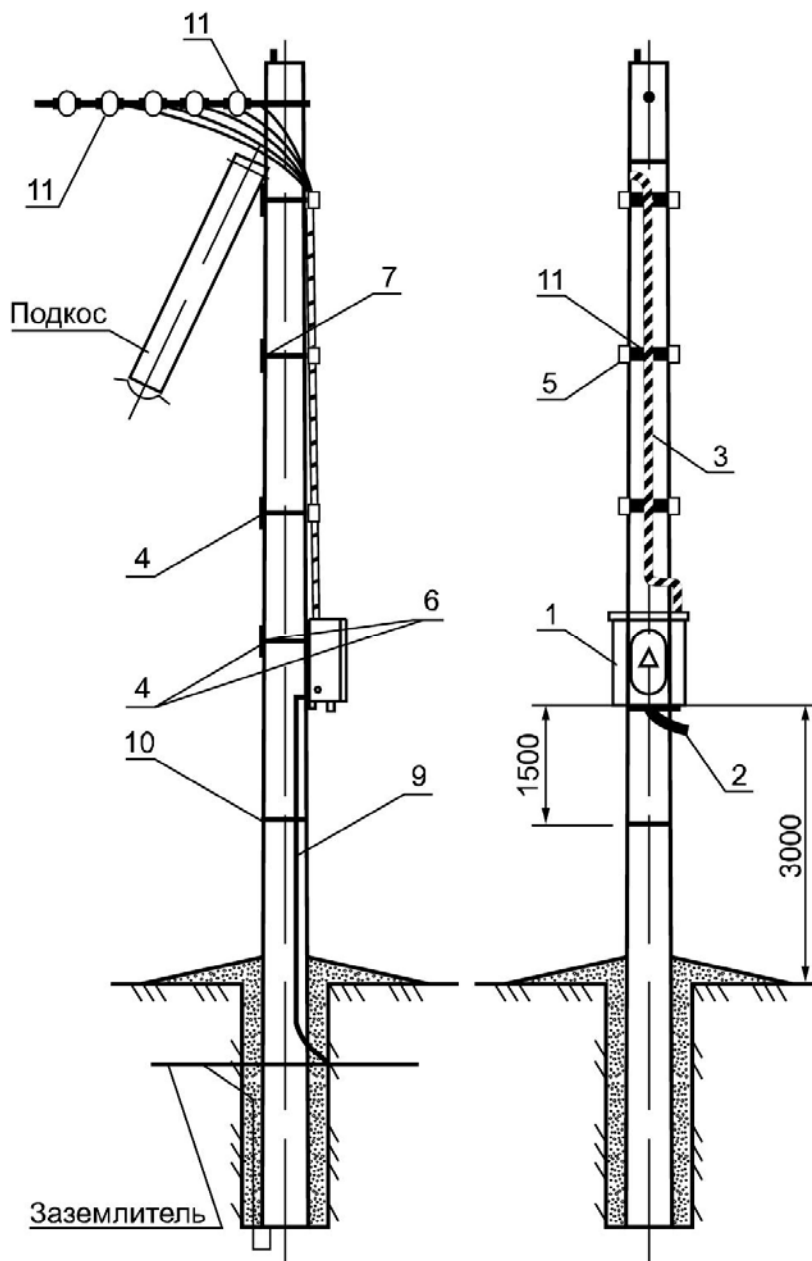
Схема установки УЗ ВЛИ на опоре
